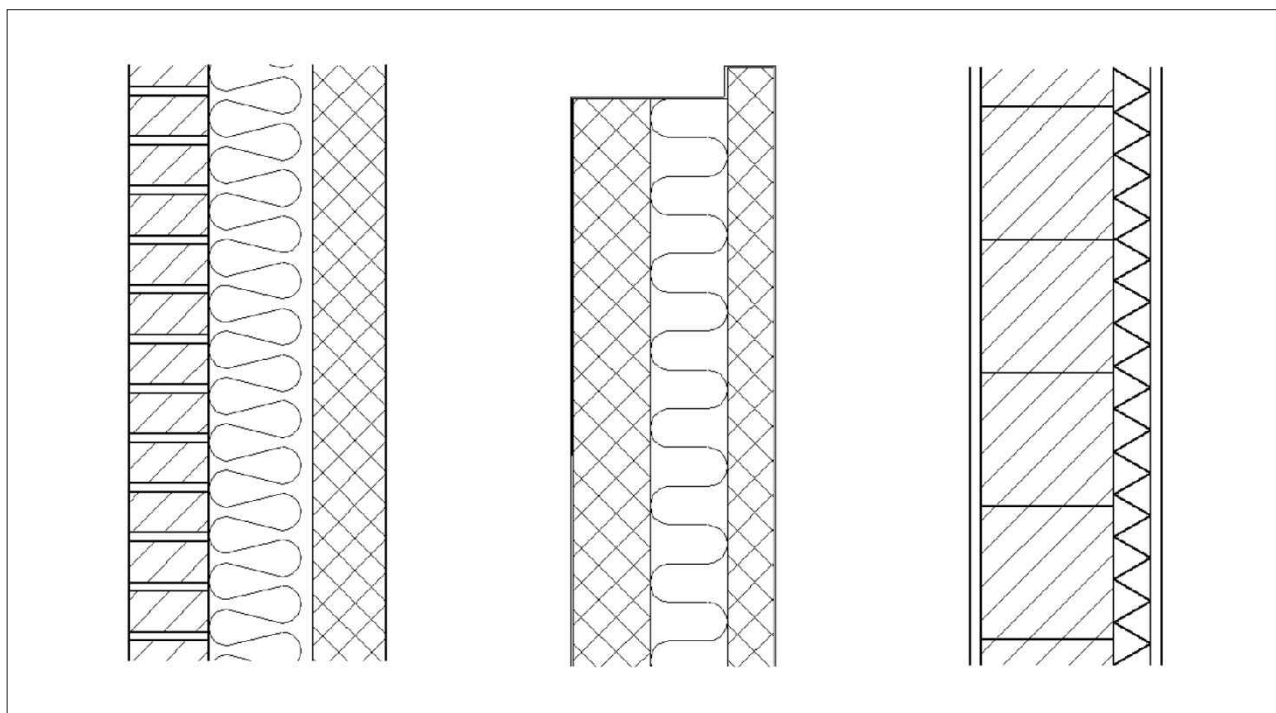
Perete clasic de cărămidă cu izolație și elemente prefabricate din beton la interior
